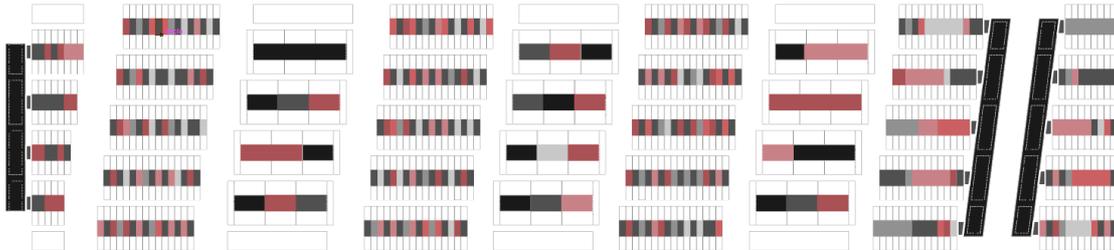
Fig. X. Unidades de gestión y edificación. AUP en Villa Constitución. Fuente: elaboración propia
